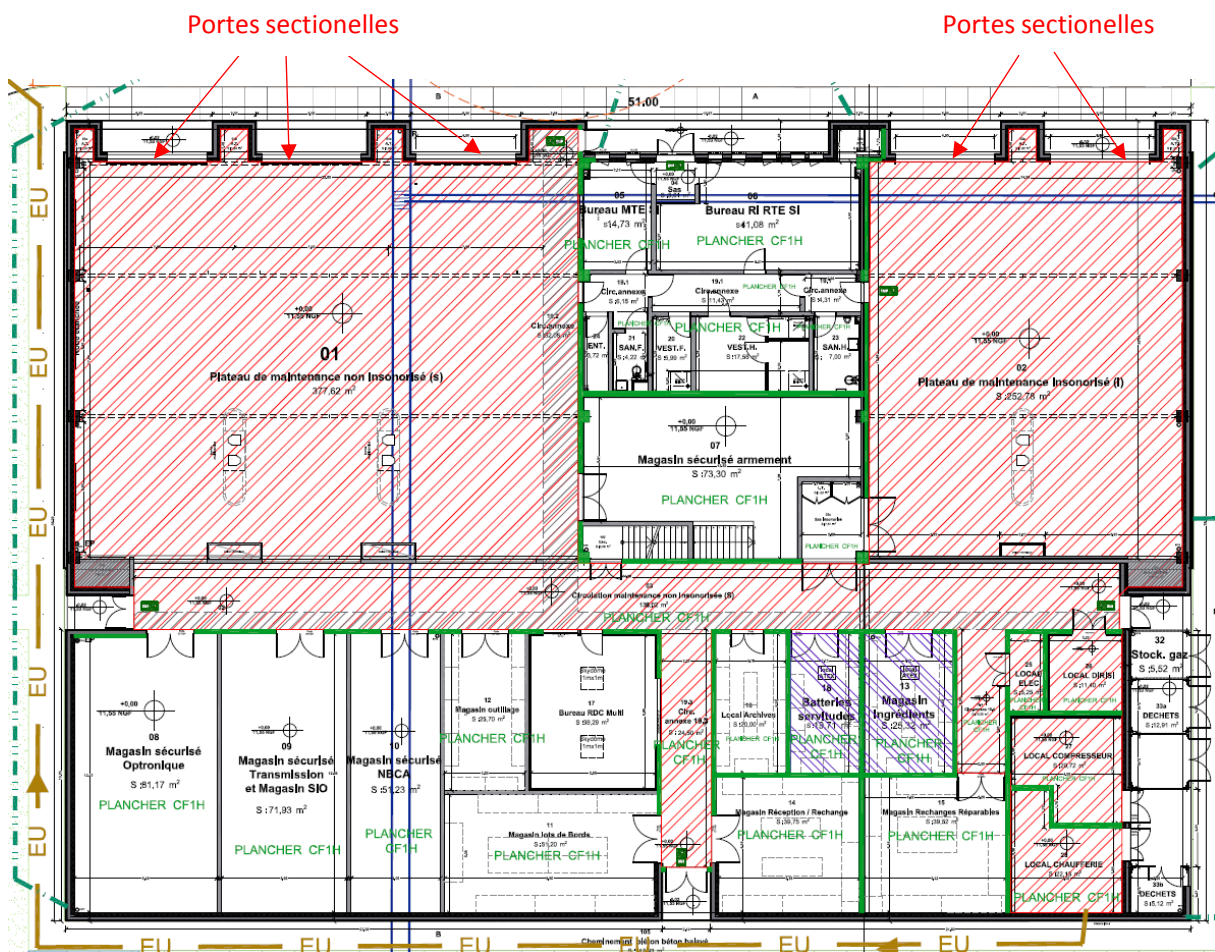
Localisation des portes sectionnelles du bâtiment projeté NT12
